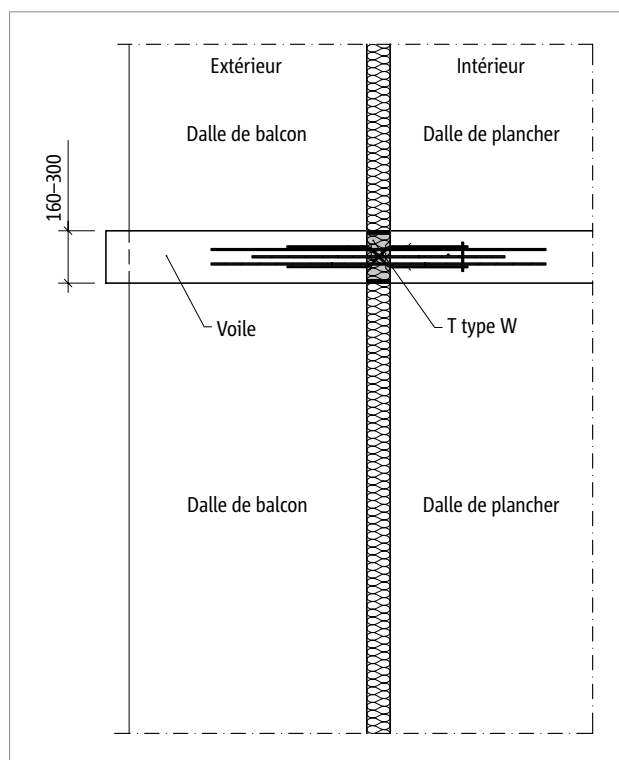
Schöck Isokorb® T Type W : Plan de base ; Construction de balcon avec murs de refend porteurs isolés thermiquement
